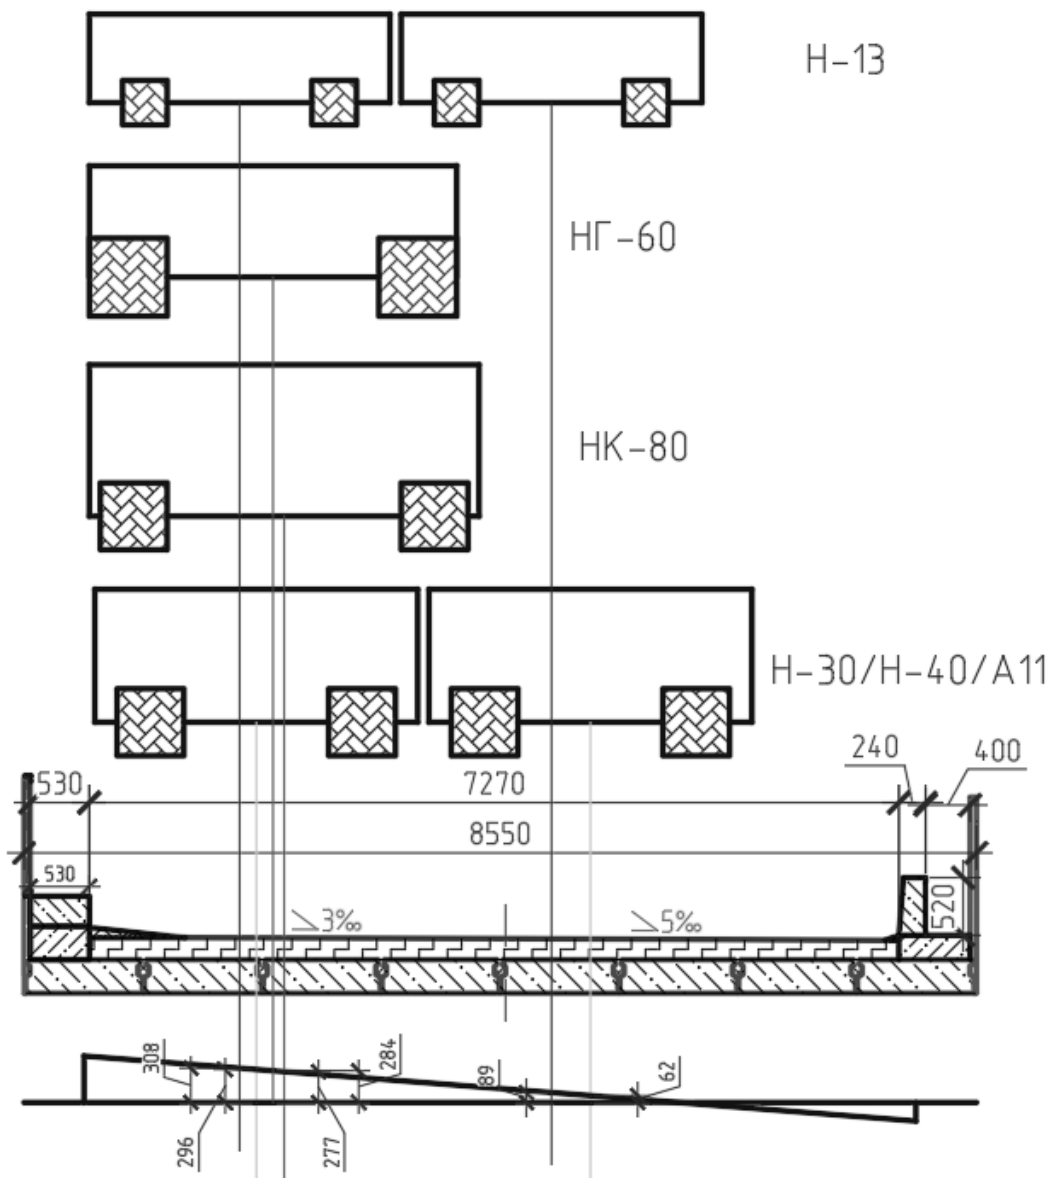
Схема завантаження прогонової будови моста (ординати збільшено в 10^3) тимчасовим навантаженням Н-30 (Н-40 і АК) та НК у поперечному перерізі та лінія впливу коефіцієнту поперечного розподілу згинального моменту посередині прогону
